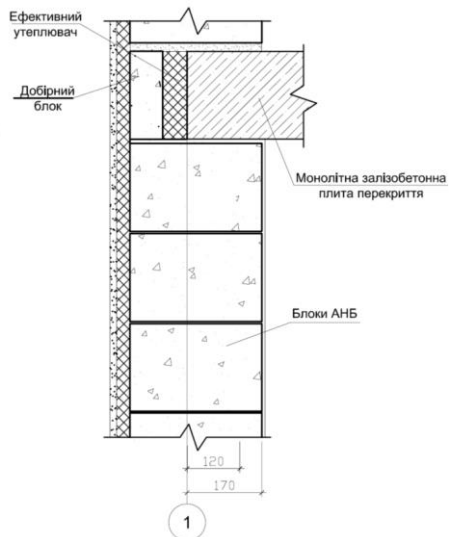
Обпирання монолітного залізобетонного перекриття на зовнішню стіну з АНБ [2]
